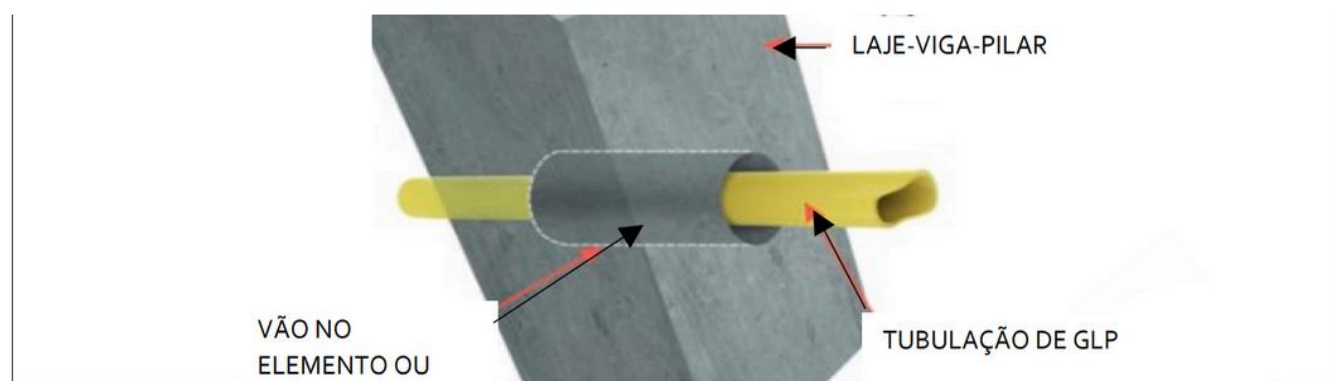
Tubo-luva atravessando elemento da estrutura predial
